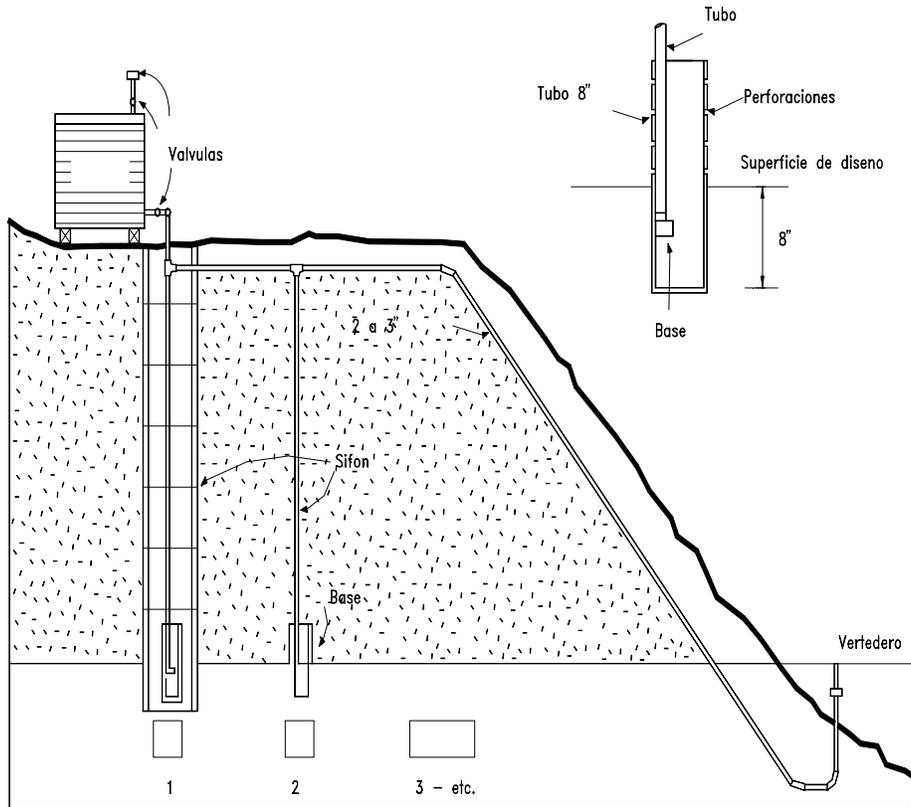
Pozos verticales de subdrenaje utilizando un sistema de bombeo y sifón.
